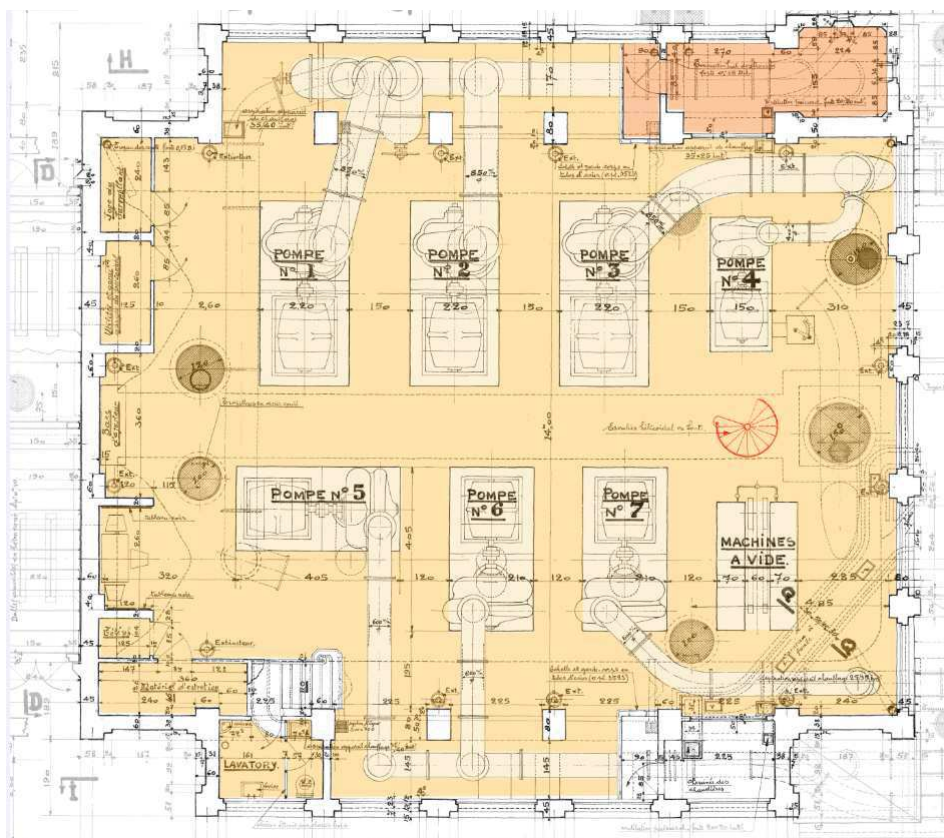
Plan du rez-de-chaussée existant et transformé – ech. 1/200
